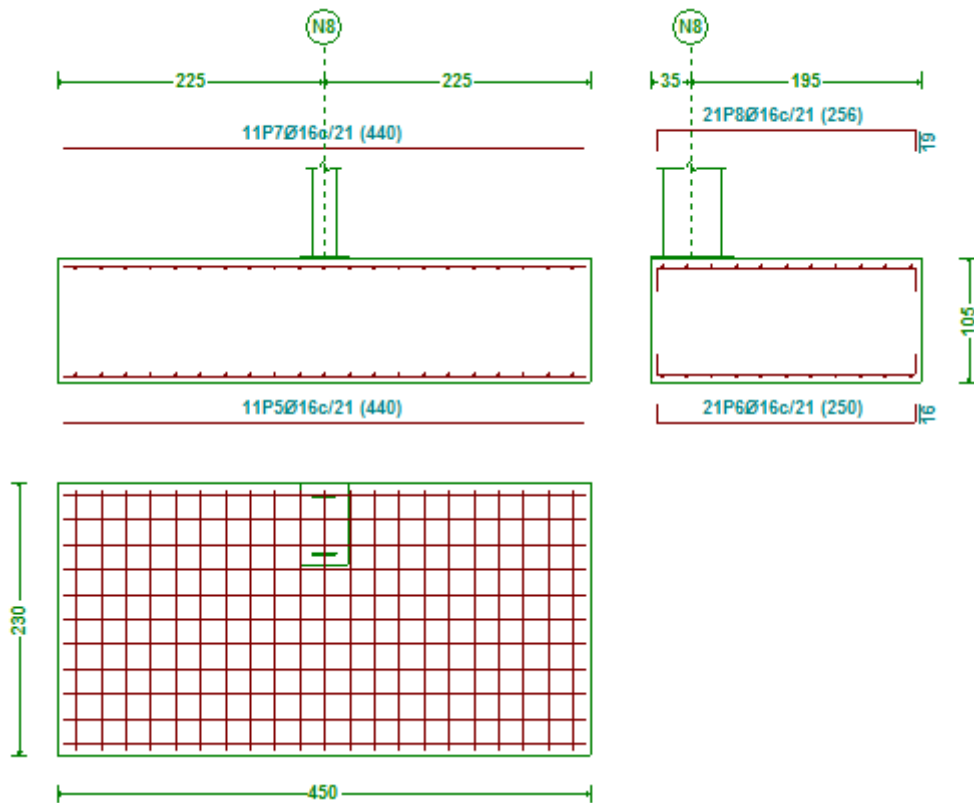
Zapatas pilar derecho de los pórticos interiores (Tipo 1)
